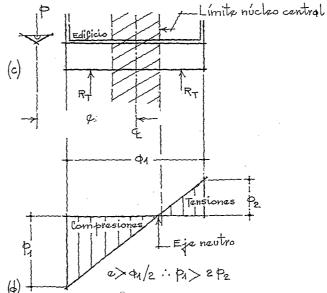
y 57. Corte esquemótico del edificio y lo cimentoción, (4).
